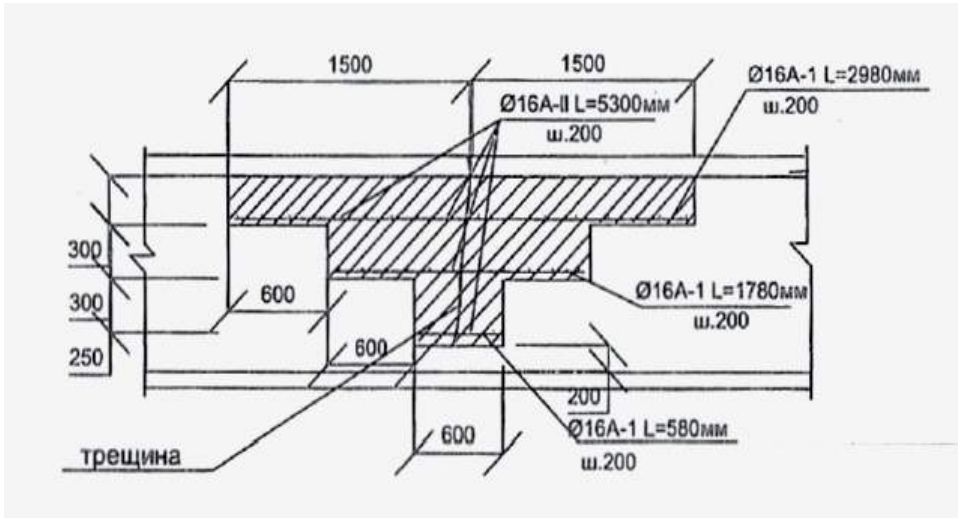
Схема усиления путем демонтажа и замоноличивания части фундамента
